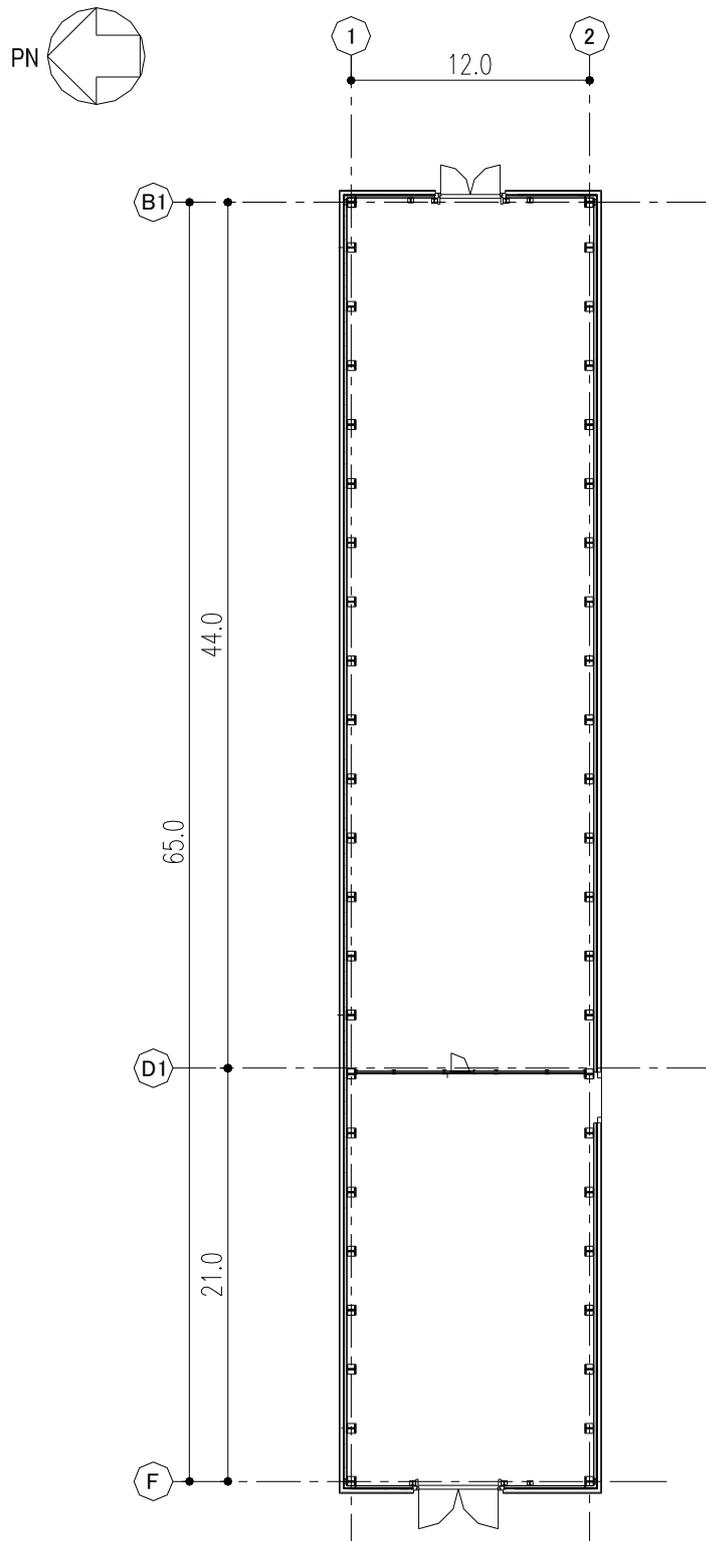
設備棟 建屋平面図 設計 G.L. +0.2 (単位 : m)
